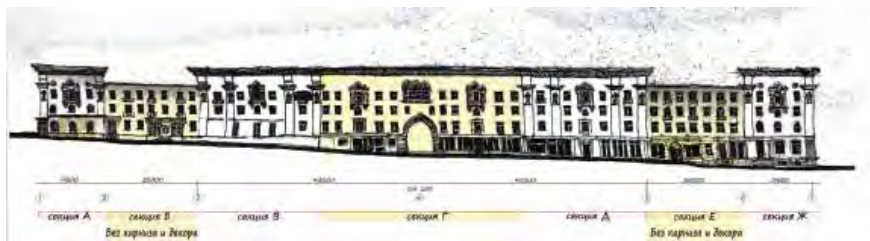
Фасад жилого дома работников ЦК. Скетч автора, 2021 г.
